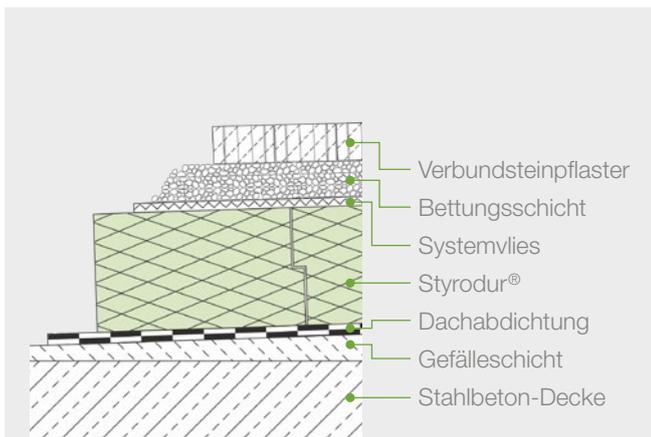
Parkdachaufbau mit Verbundsteinpflaster auf einer Bettungsschicht.
